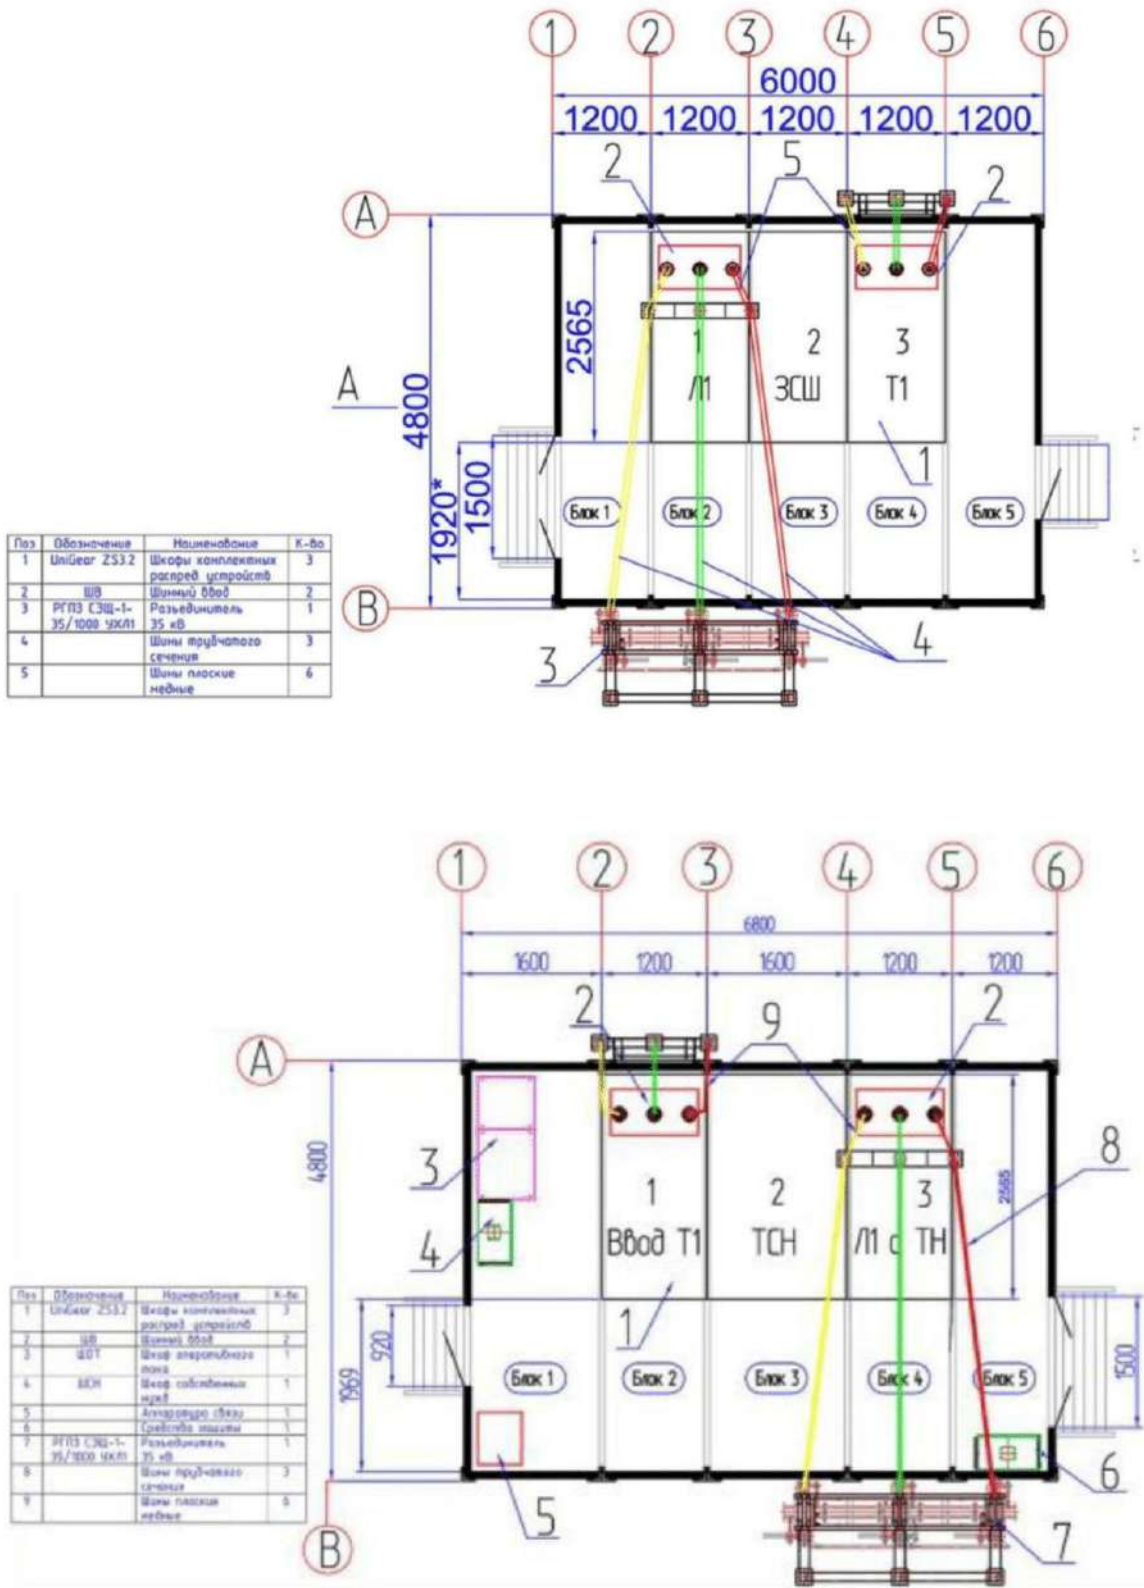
План расположения электрооборудования КРУ-35 кВ в блочно-модульном здании
